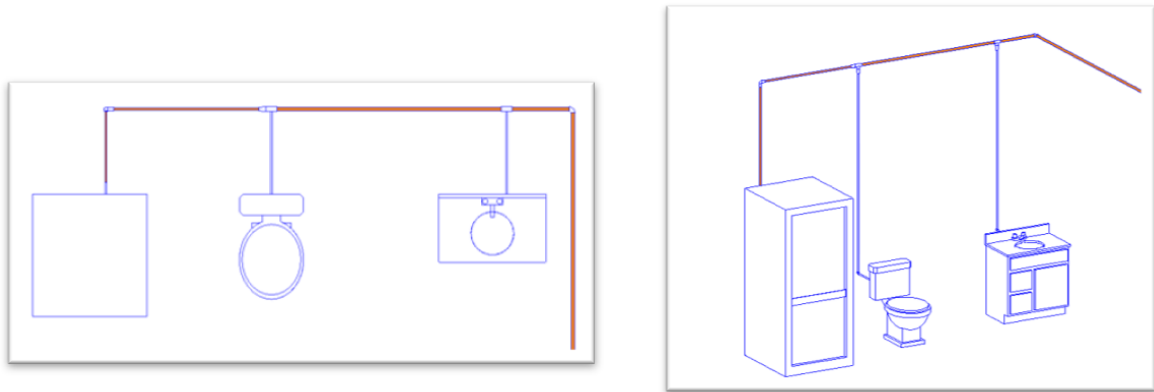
Vista em planta e vista 3D após a aplicação do filtro criado
